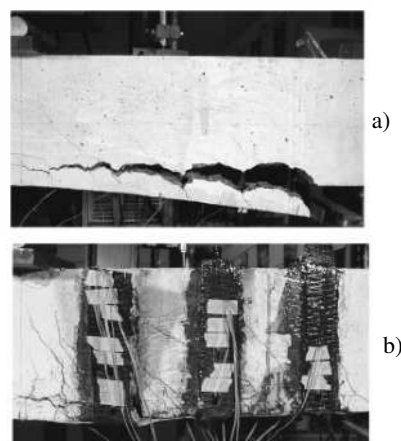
Comportamento a rottura di travi in c.a. rinforzate con FRP: a) trave senza collegamenti trasversali; b) trave con collegamenti trasversali [23]
